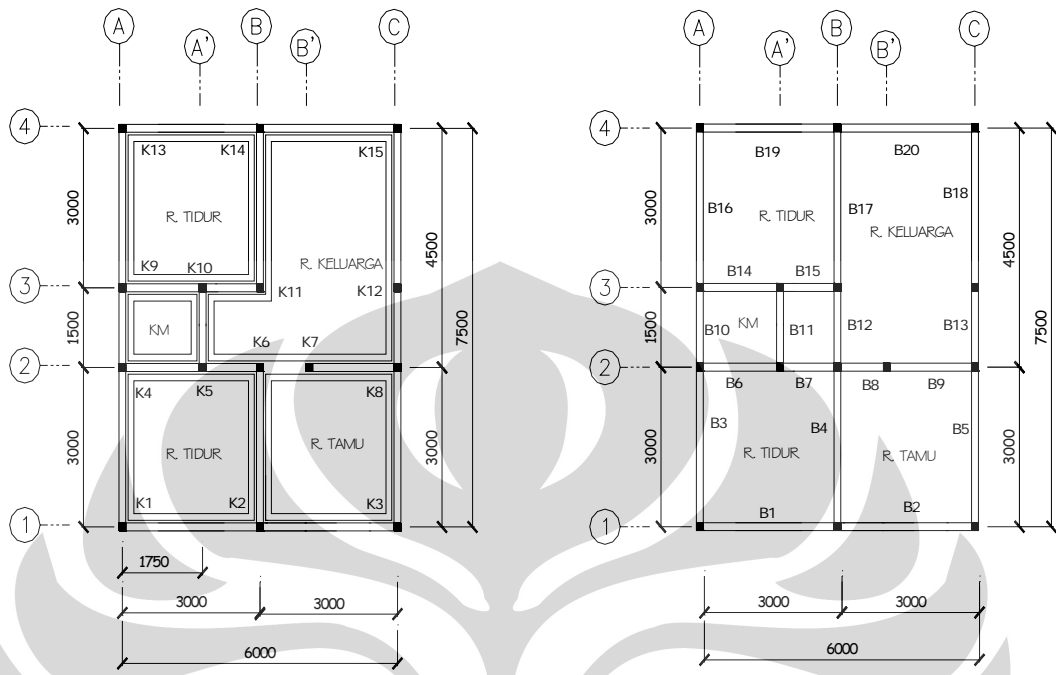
Gambar denah dan pondasi bangunan satu lantai
